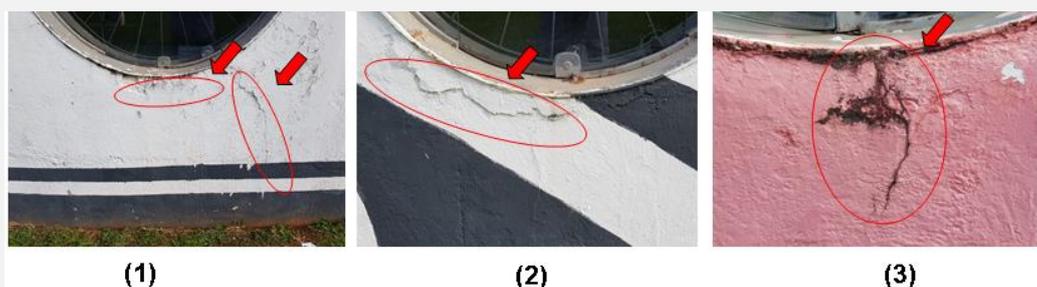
Fissuras abaixo da janela. Fonte: Autores.
